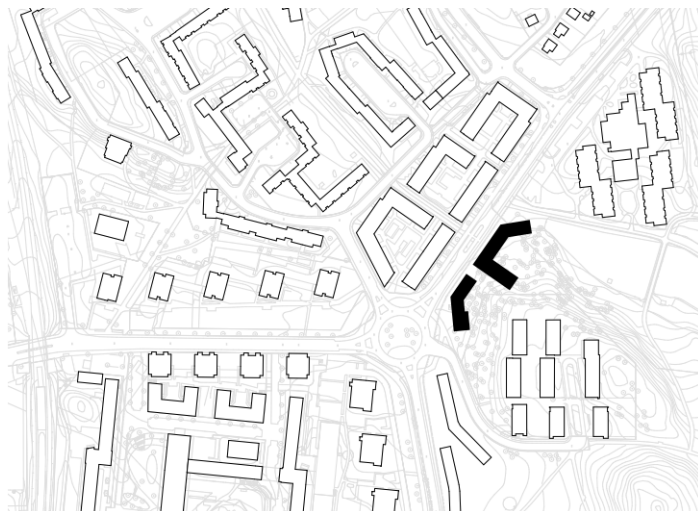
Situationsplan Björketorpsvägen. Projektet består av två huskroppar. Södra huset och Norra huset.
